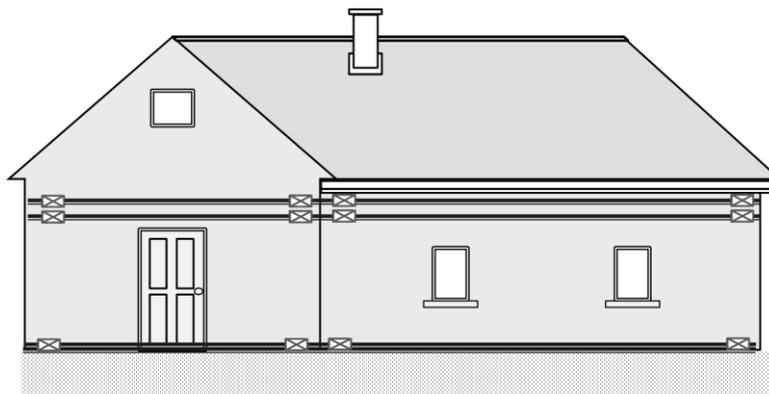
exemple de la consolidation d'un bâtiment par câbles périphériques
